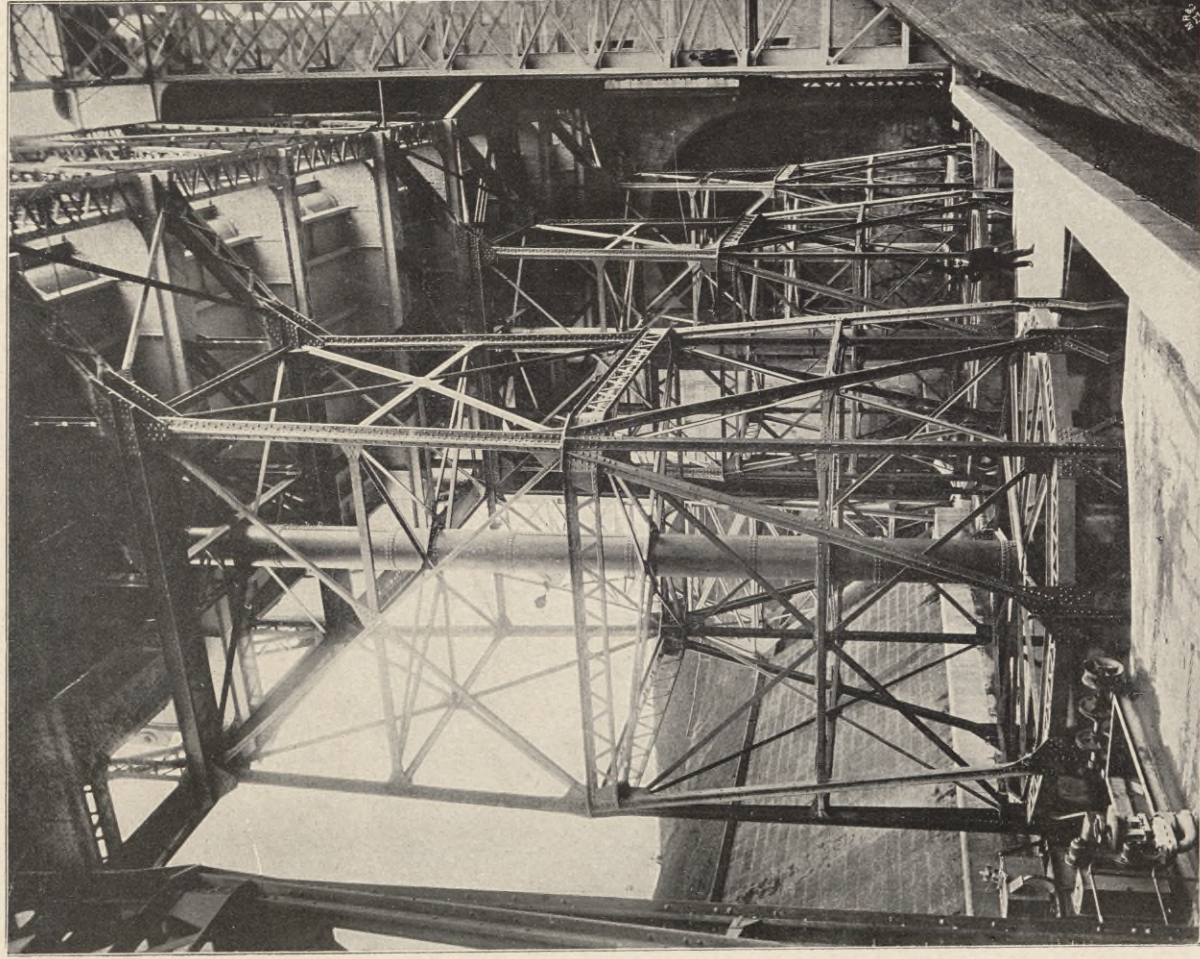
EISENKONSTRUKTIONEN ZUM SCHIFFSHEBEWERK
